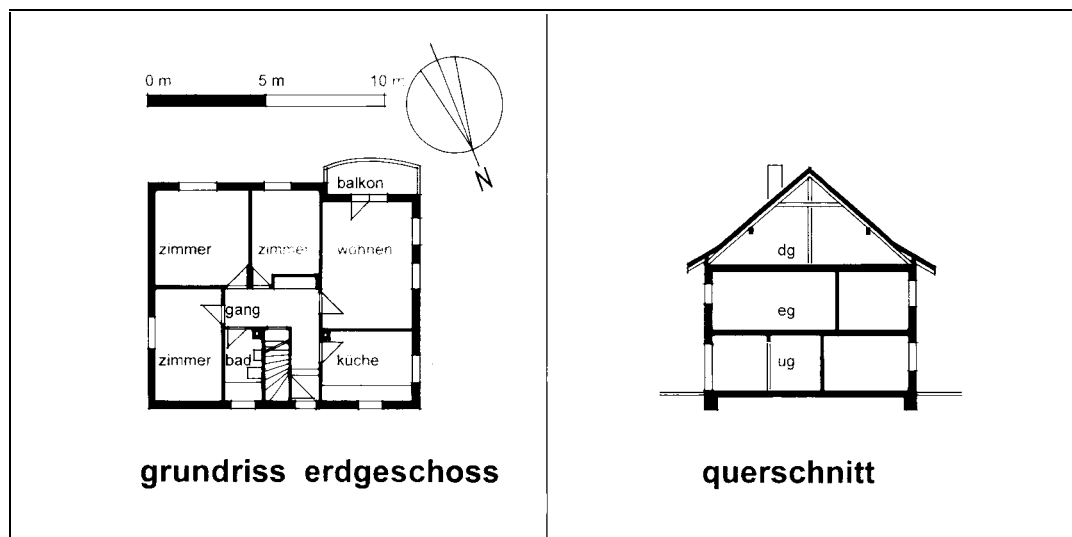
Grundriss Erdgeschoß und Querschnitt von Objekt 2.
